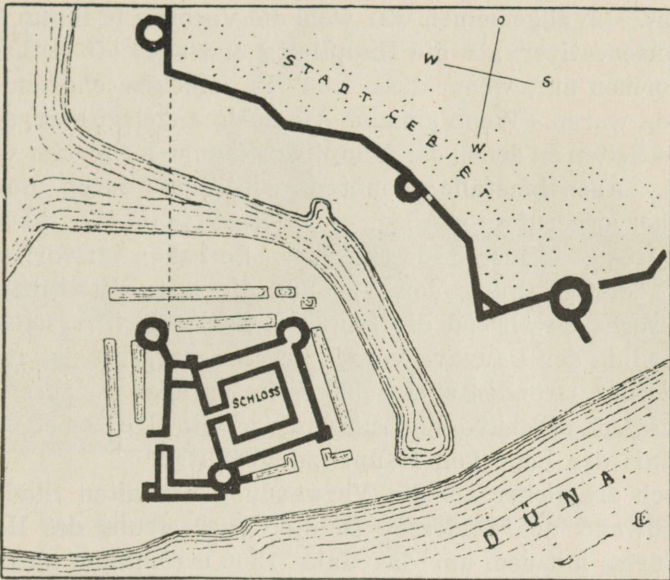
Grundriss der Burg aus dem Jahre 1646. Nach Neumann.
